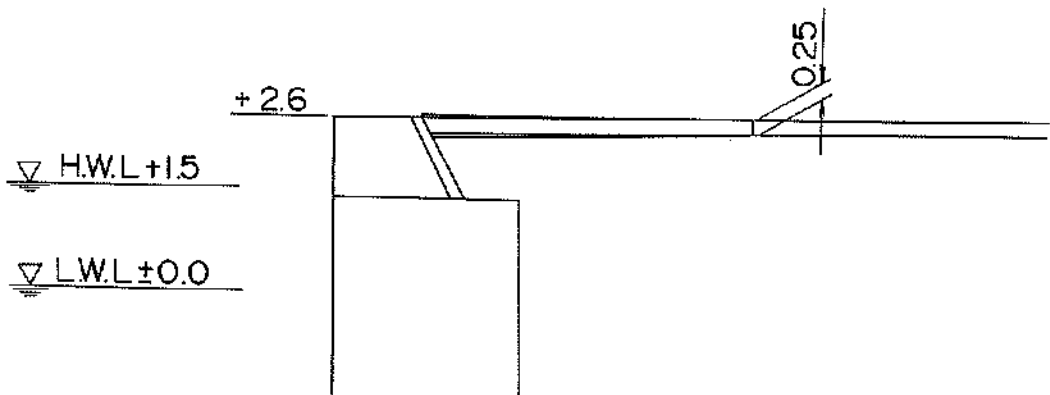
被災状況平面図, 断面図 (十勝港, ②岸壁(南-5.5m))
